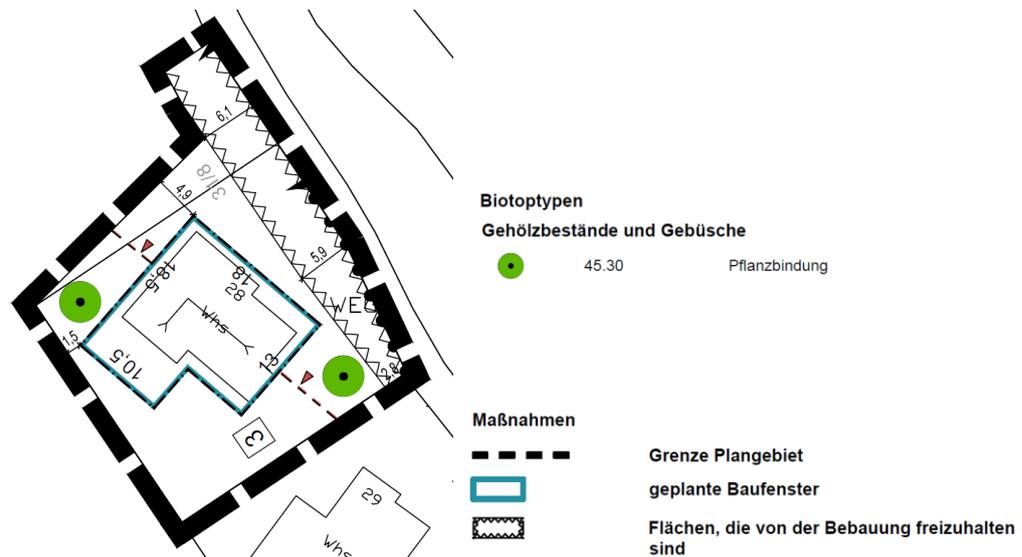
Maßnahmenplan (Quelle: galaplan decker, Stand 13.05.2024).
